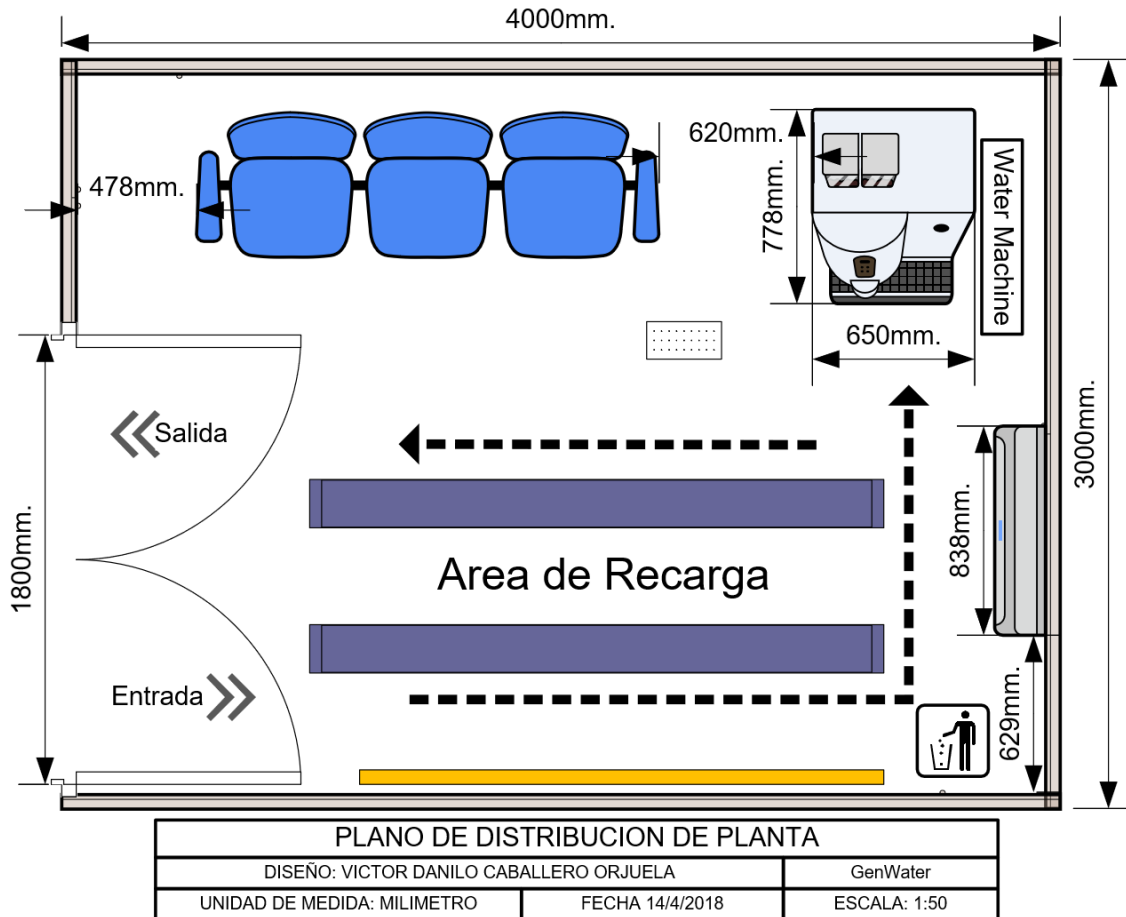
Distribución de la planta de GenWater. (Medidas en MM).
